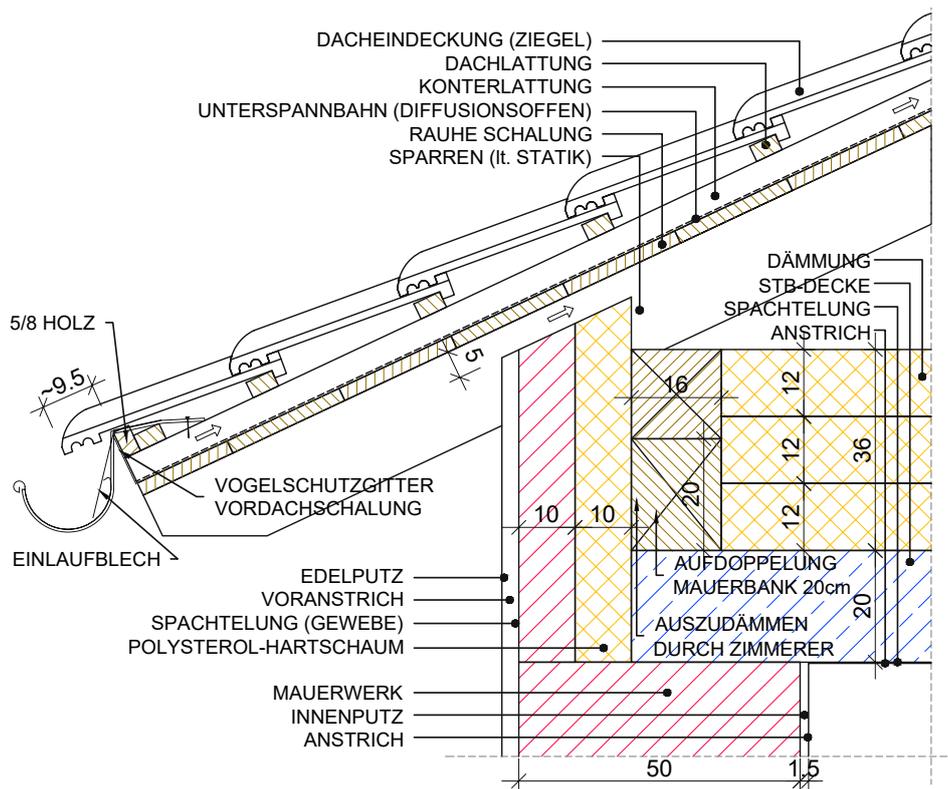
Traufenschnitt durch die Mauerbank und Dachkonstruktion [39]
